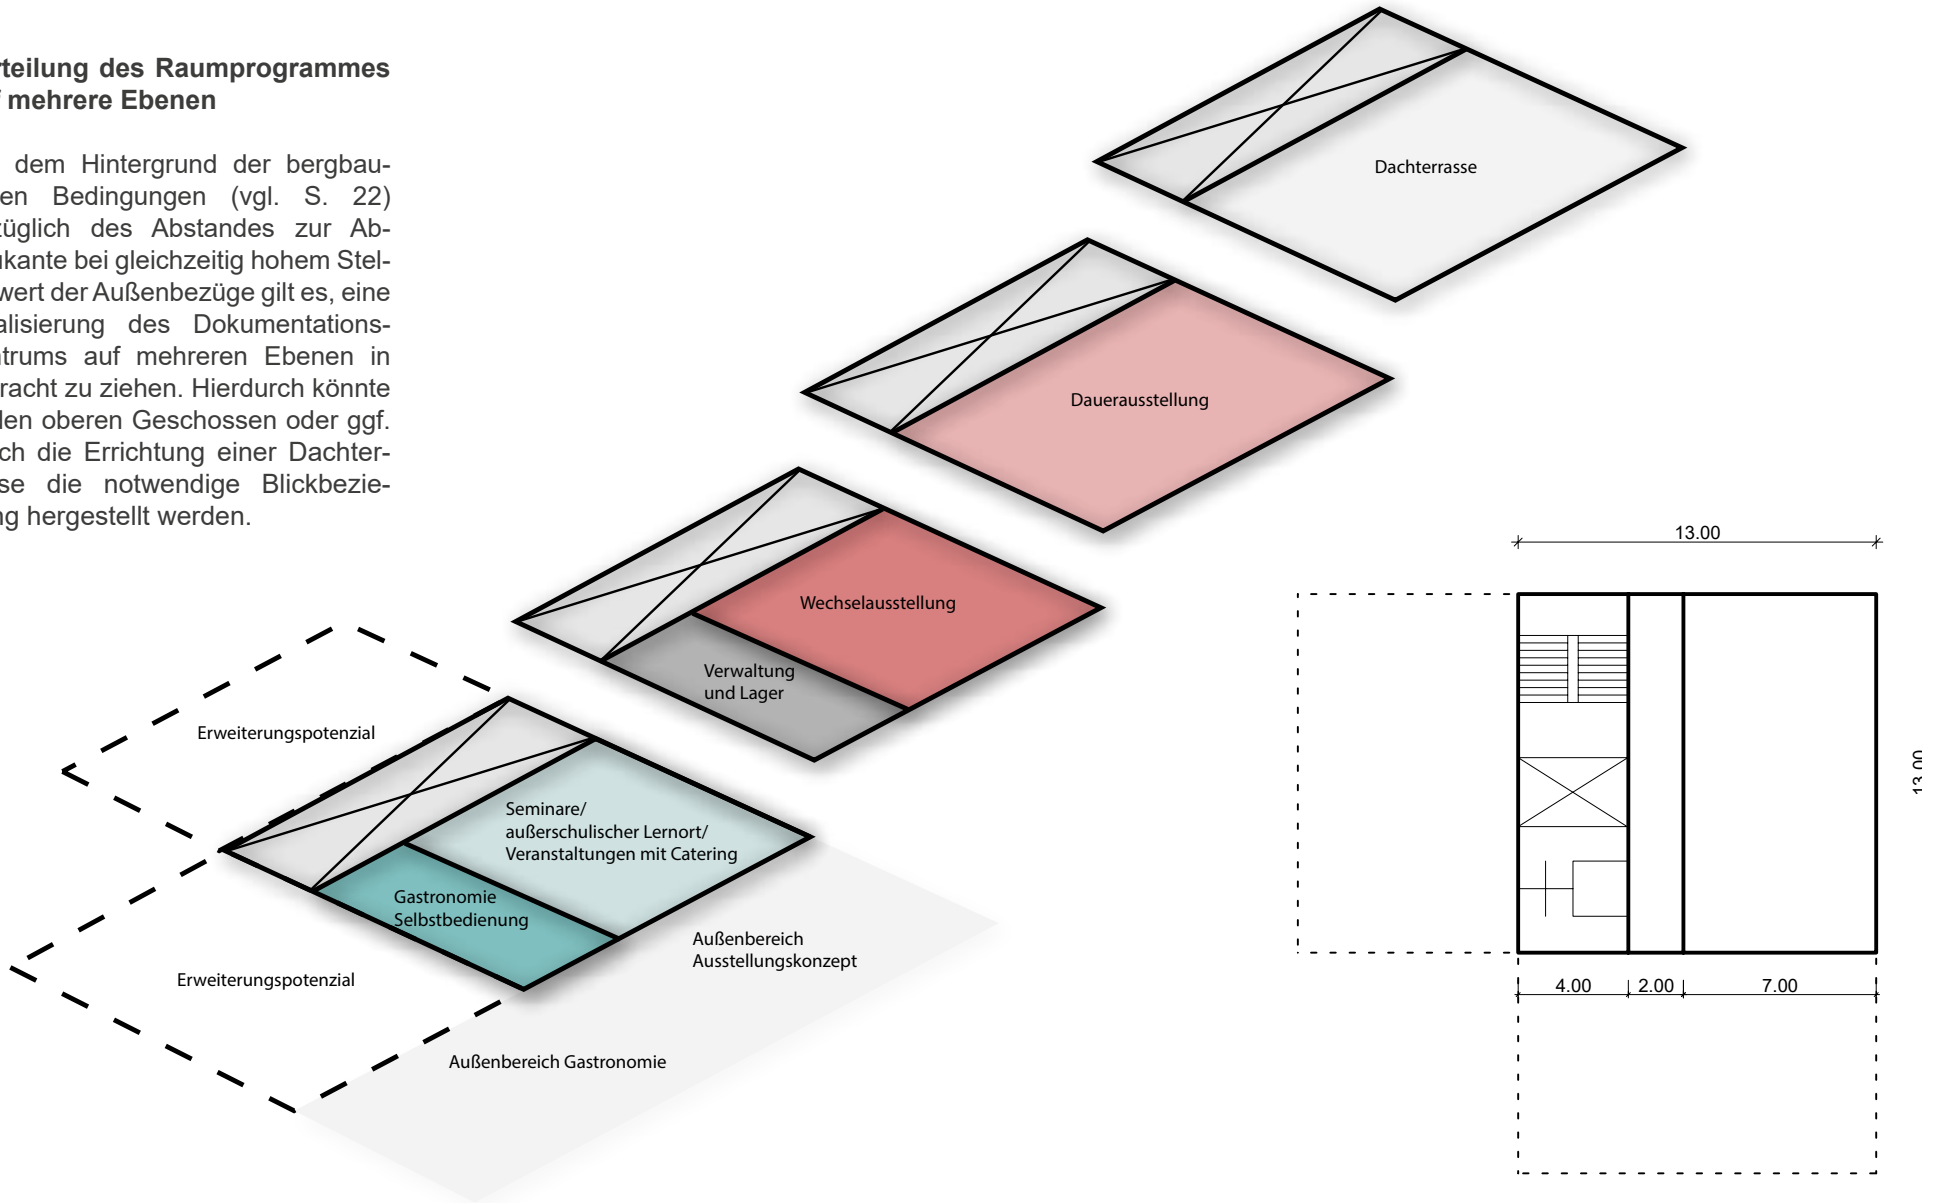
Prinzipgrundriss und Ebenendarstellung
